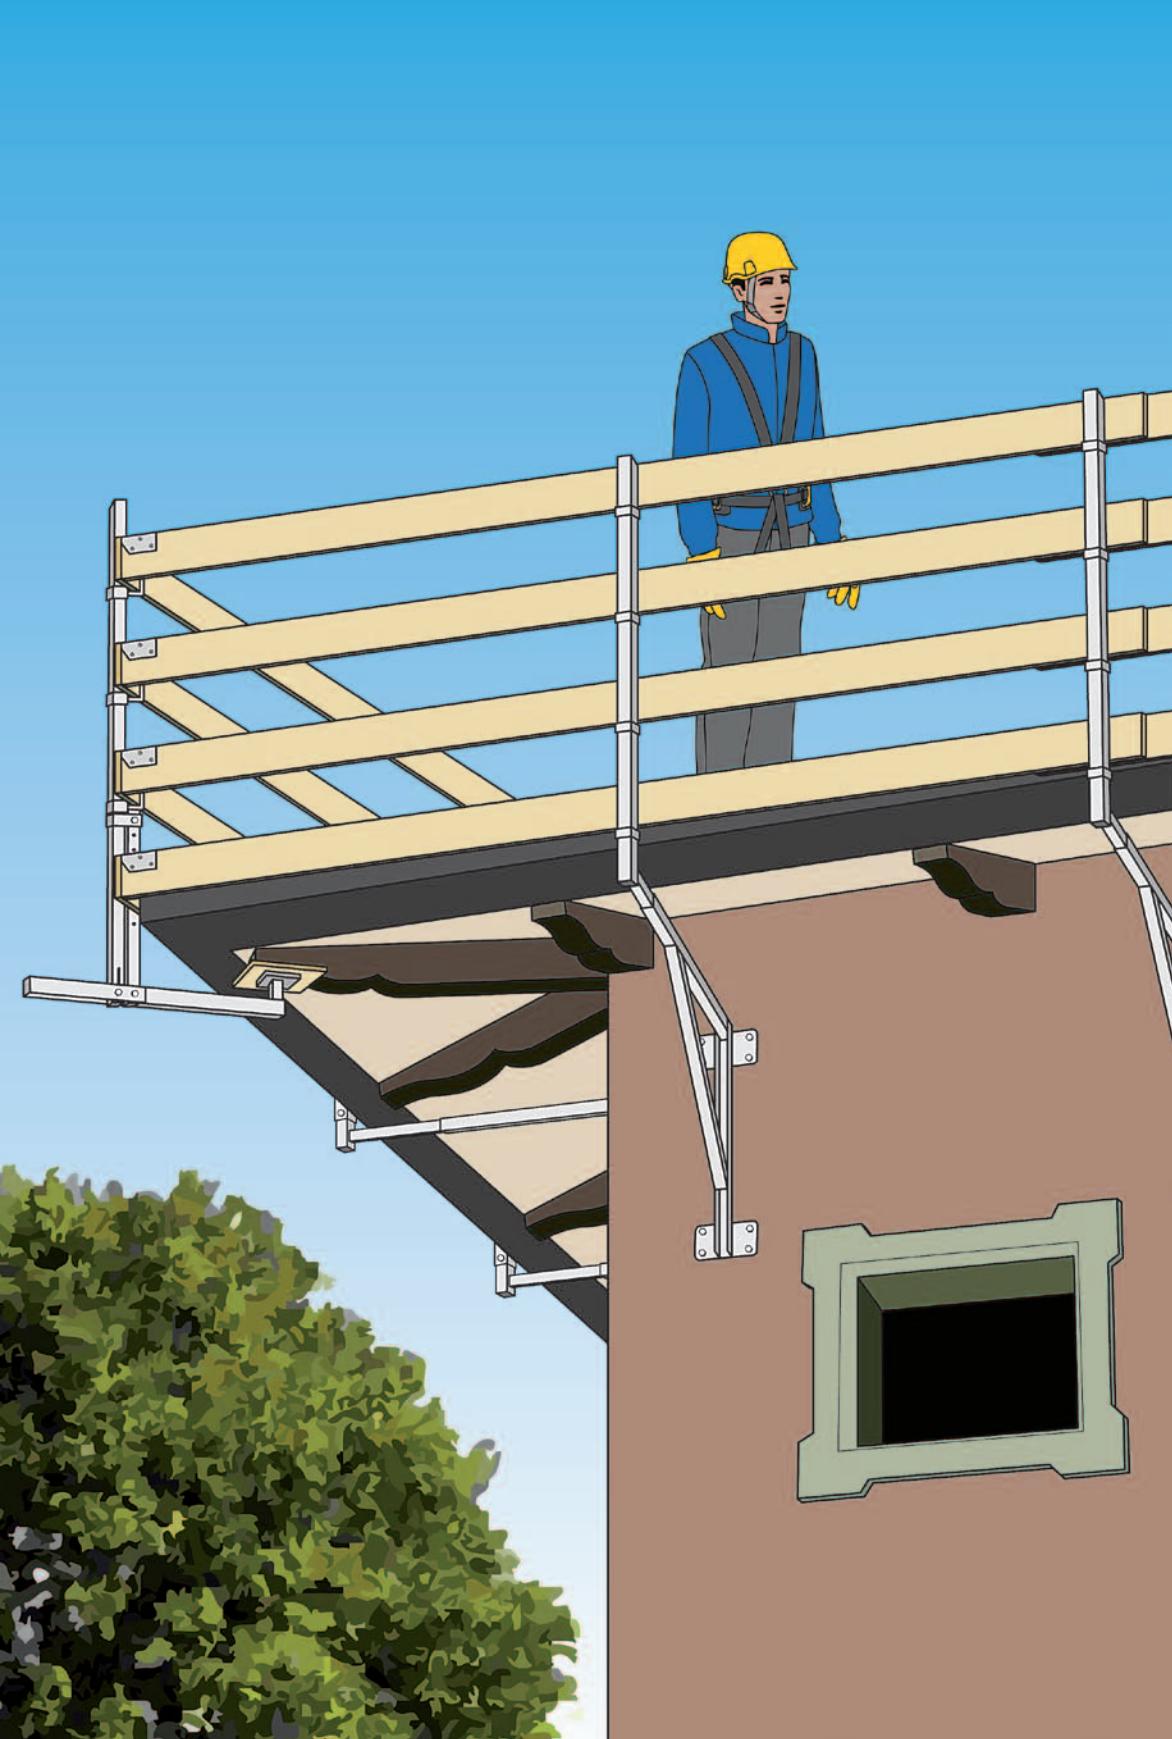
Parapetto provvisorio su legno, montaggio/smontaggio
